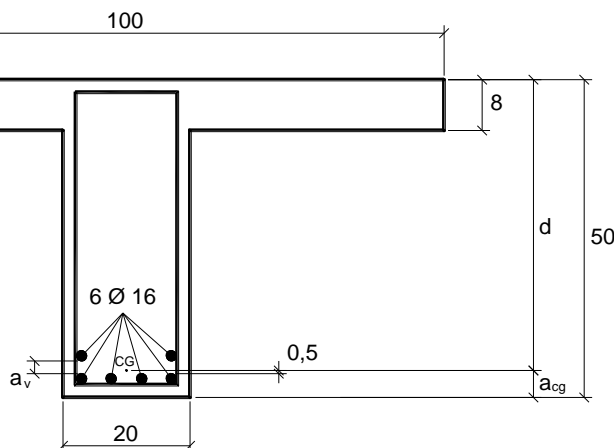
Detalhamento da armadura longitudinal na seção transversal.
